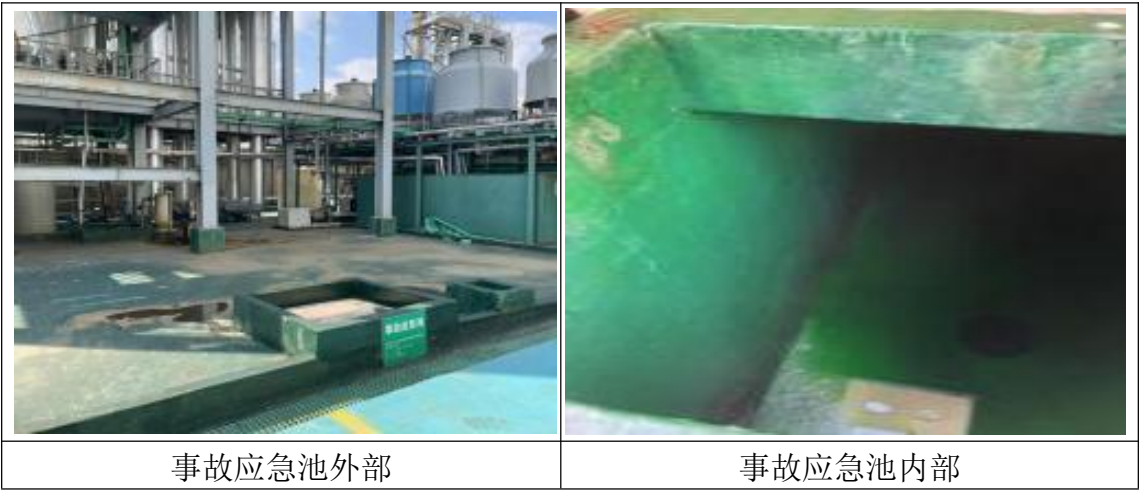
事故池及初期雨水收集系统现场布置图
